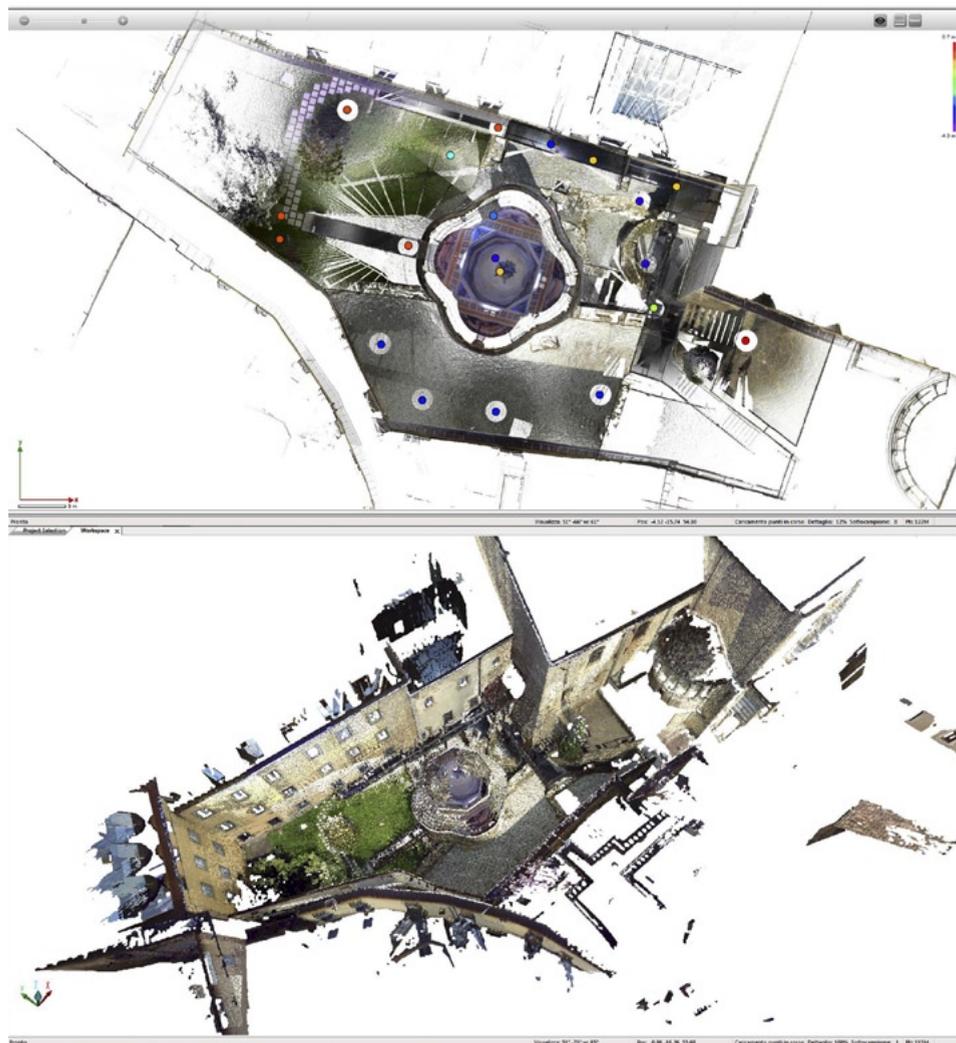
La chiesa di Santa Croce: la planimetria con indicazione delle stazioni e il modello 3D della chiesa e del cortile dell’episcopato.
